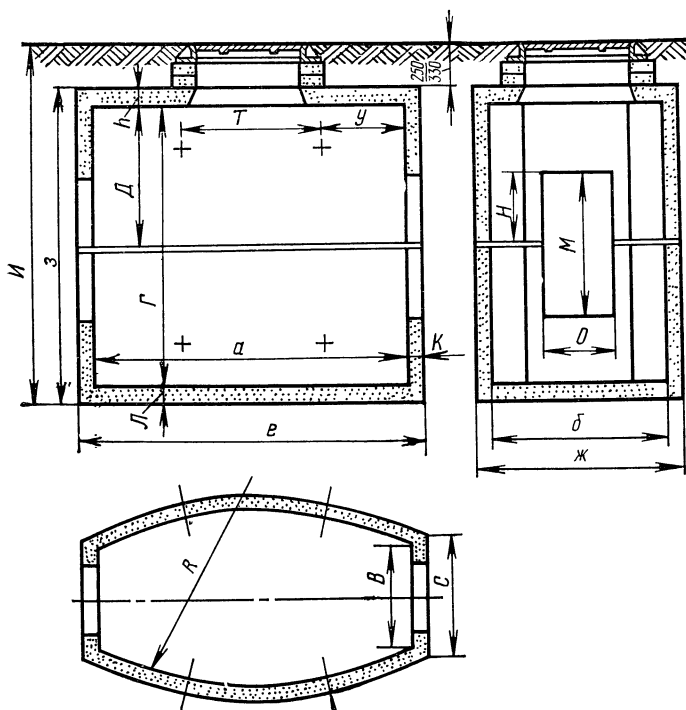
Конструкция проходных сборных и монолитных железобетонных колодцев типов ККС-2, ККС-3, ККС-4 и ККС-5 овальной формы
